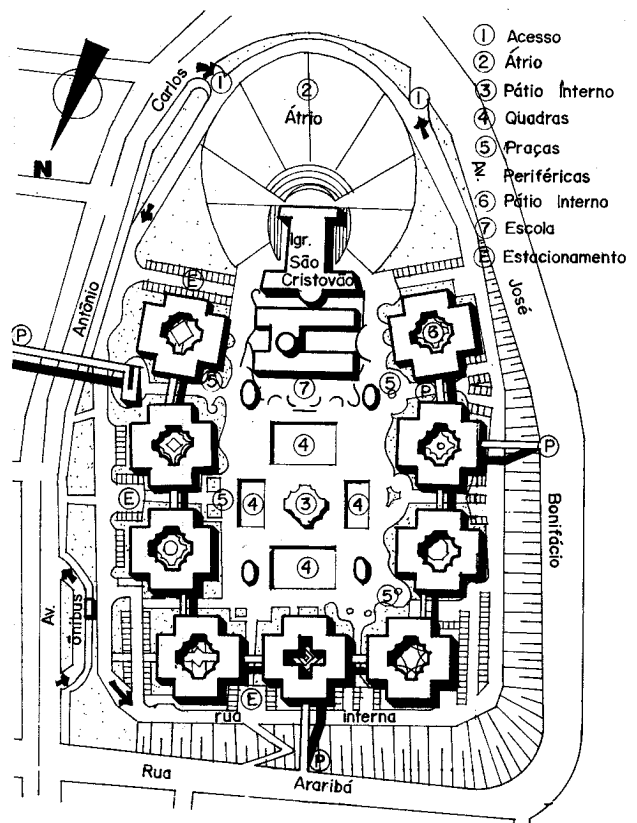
Planta do Conjunto I.A.P.I./Proposta
